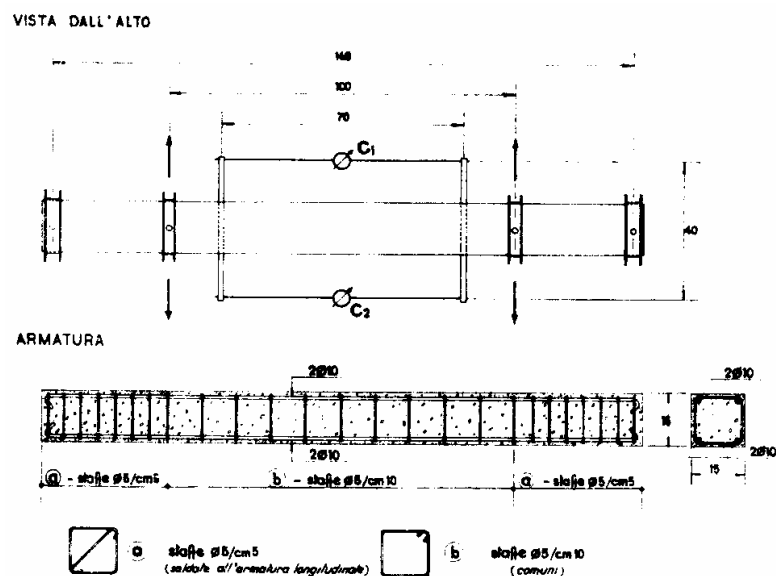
da Giuffrè & Pinto (1970). Travetto armato simmetricamente sollecitato a flessione retta ciclica.
